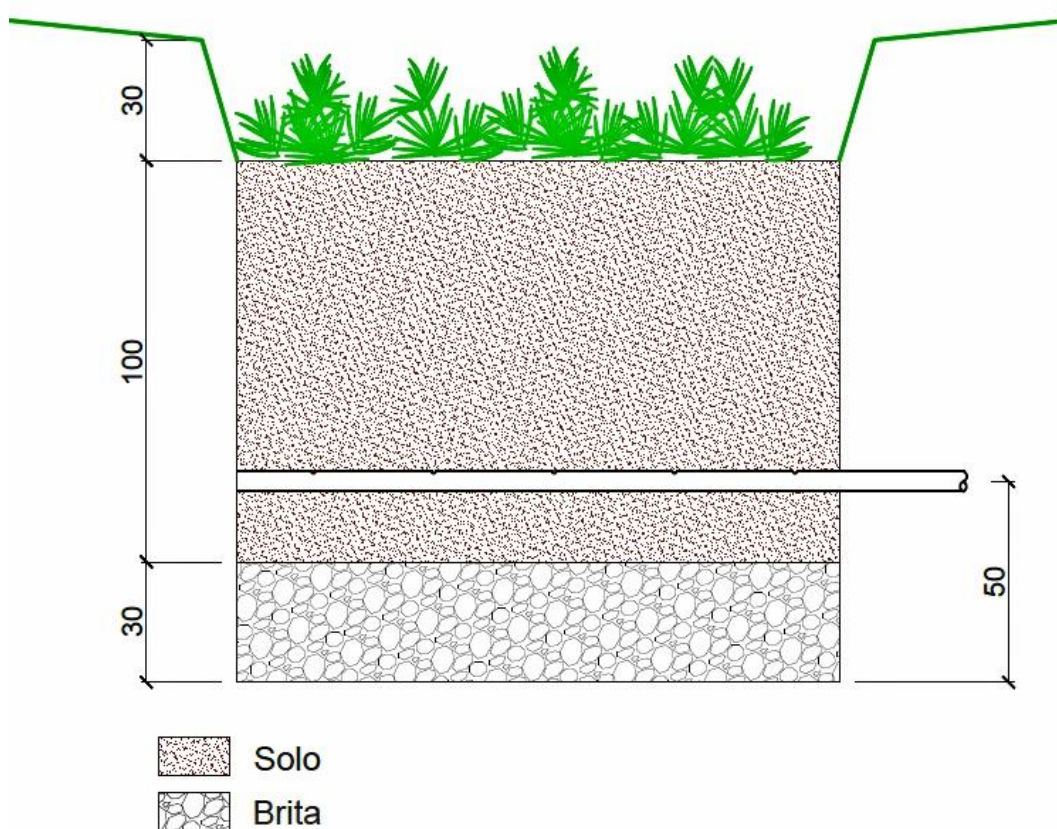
Dispositivo de biorretenção padrão dimensionado
